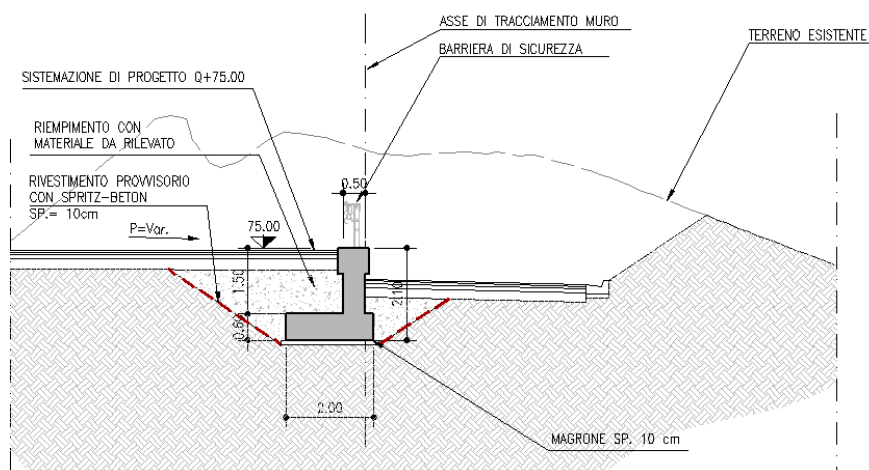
Muro di sostegno MS04 – Sezione tipo 2
